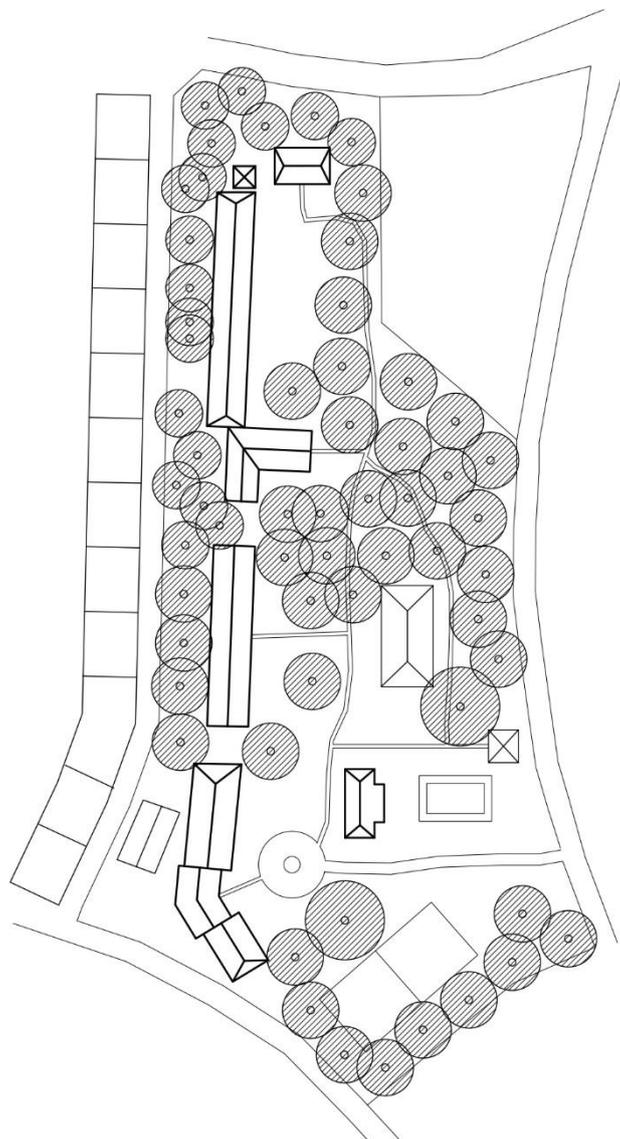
Planta de cobertura da Quinta da Bela Vista, escala 1:2000
